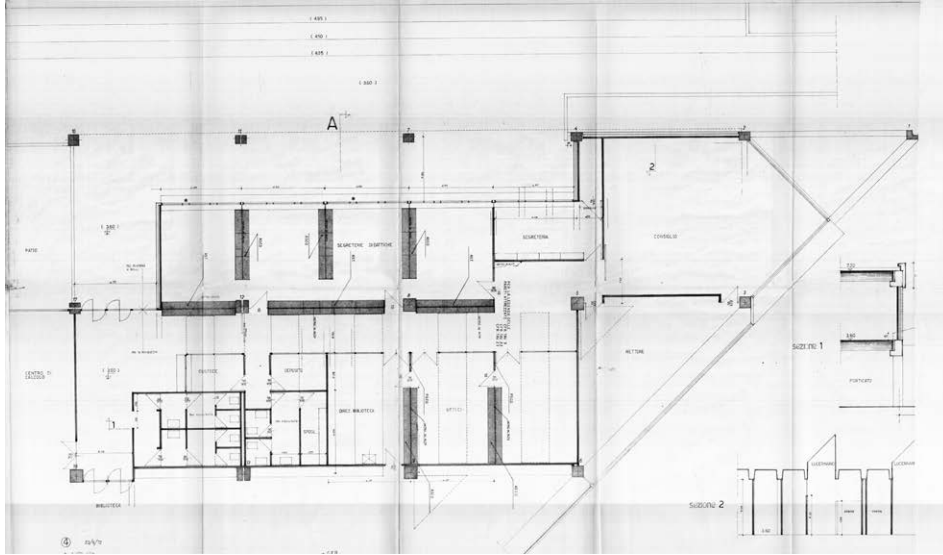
Pianta degli uffici, 1973. In evidenza le pareti attrezzate con armadiature. ASTO-Borini, f. cemento armato 1956-83, m. 906.
